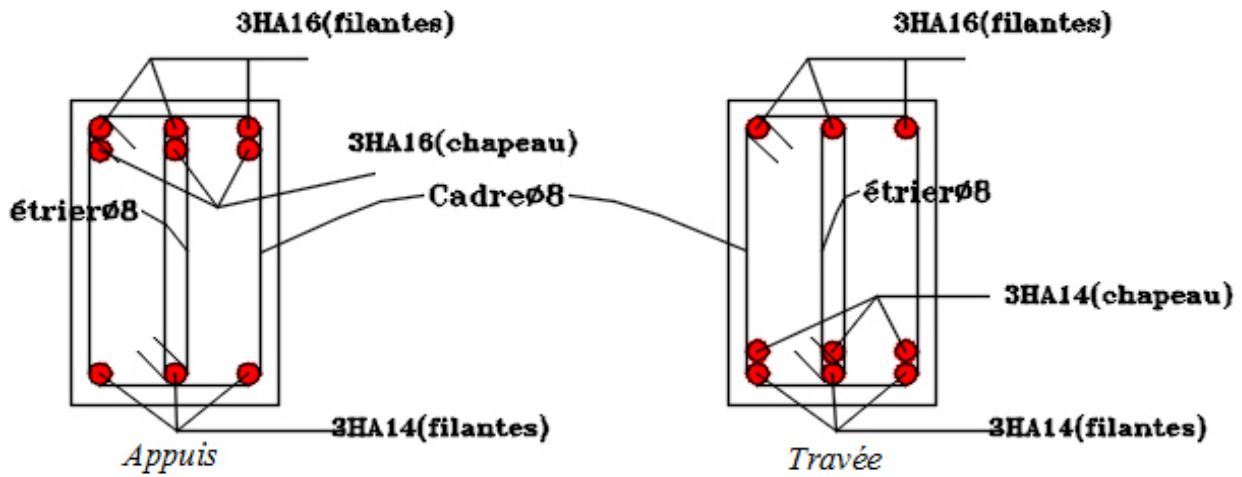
schéma de ferrailage des poutres secondaires des étages courants
